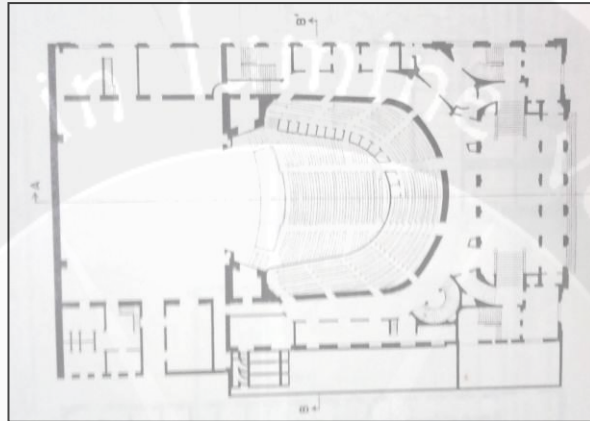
Ruang Pertunjukan dengan Bentuk Lantai Tidak Teratur
